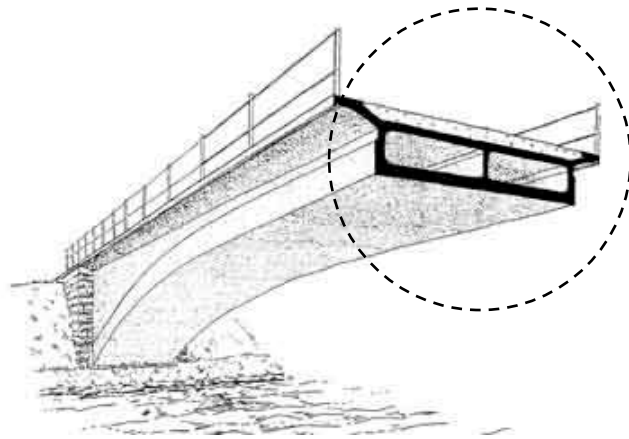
Vista e detalhe construtivo da seção transversal do tabuleiro da Ponte Zuoz, Suíça. Fonte: Adaptada de Nicolas Janberg
